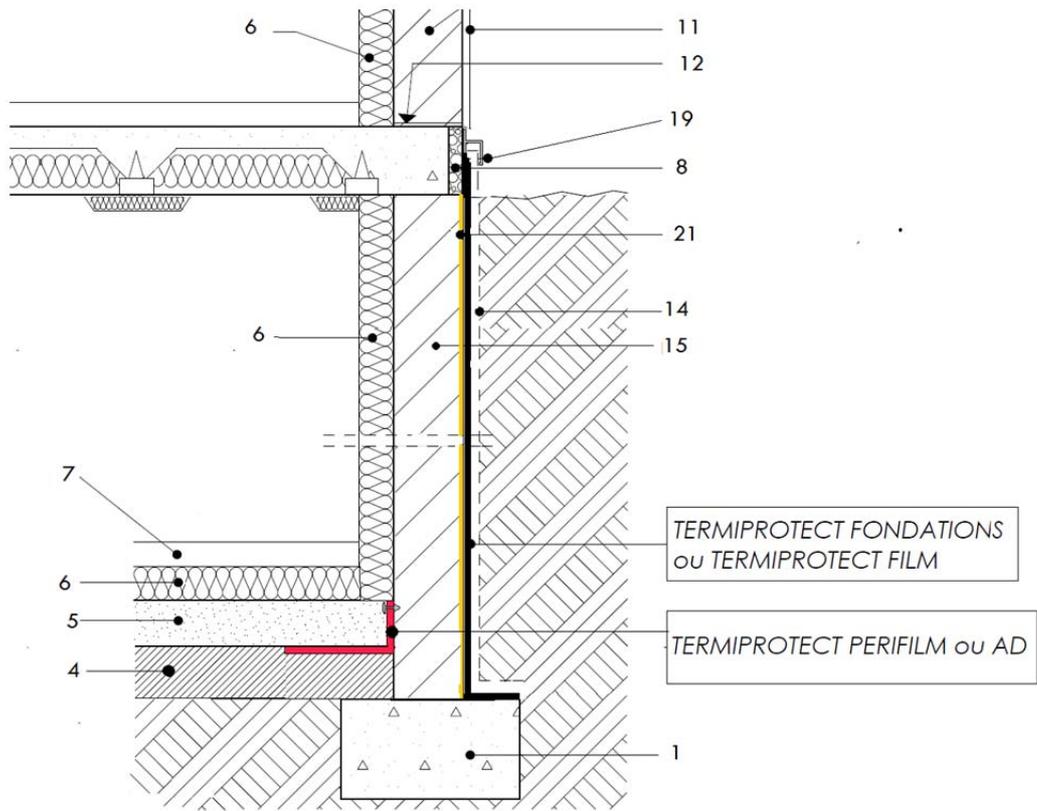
Construction sur sol-sol habité, murs enterrés en maçonnerie
